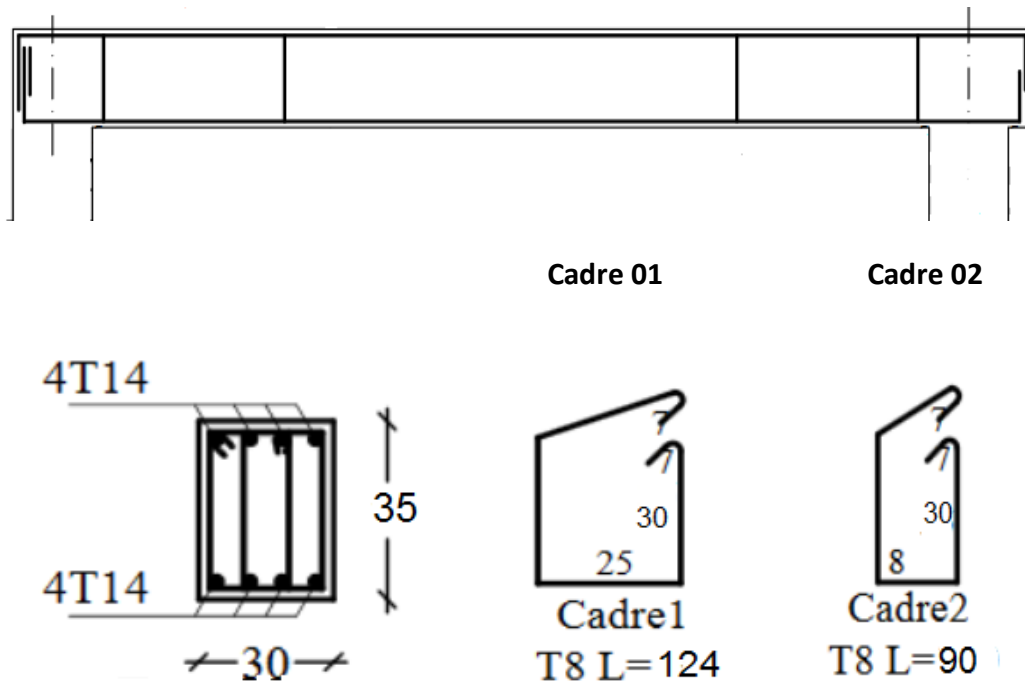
ferraillage de la poutre secondaire (30×35)
